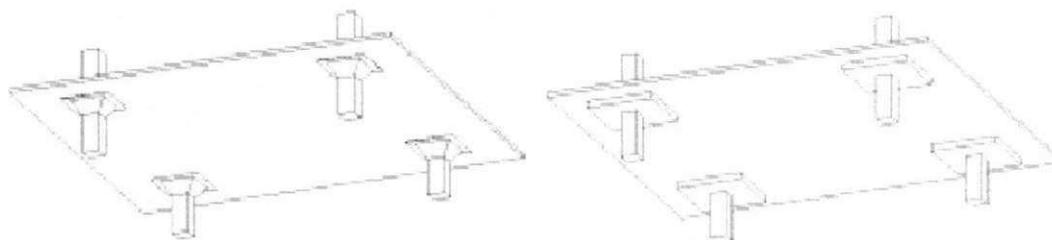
Laje cogumelo: (a) com capitel (b) com engrossamento
